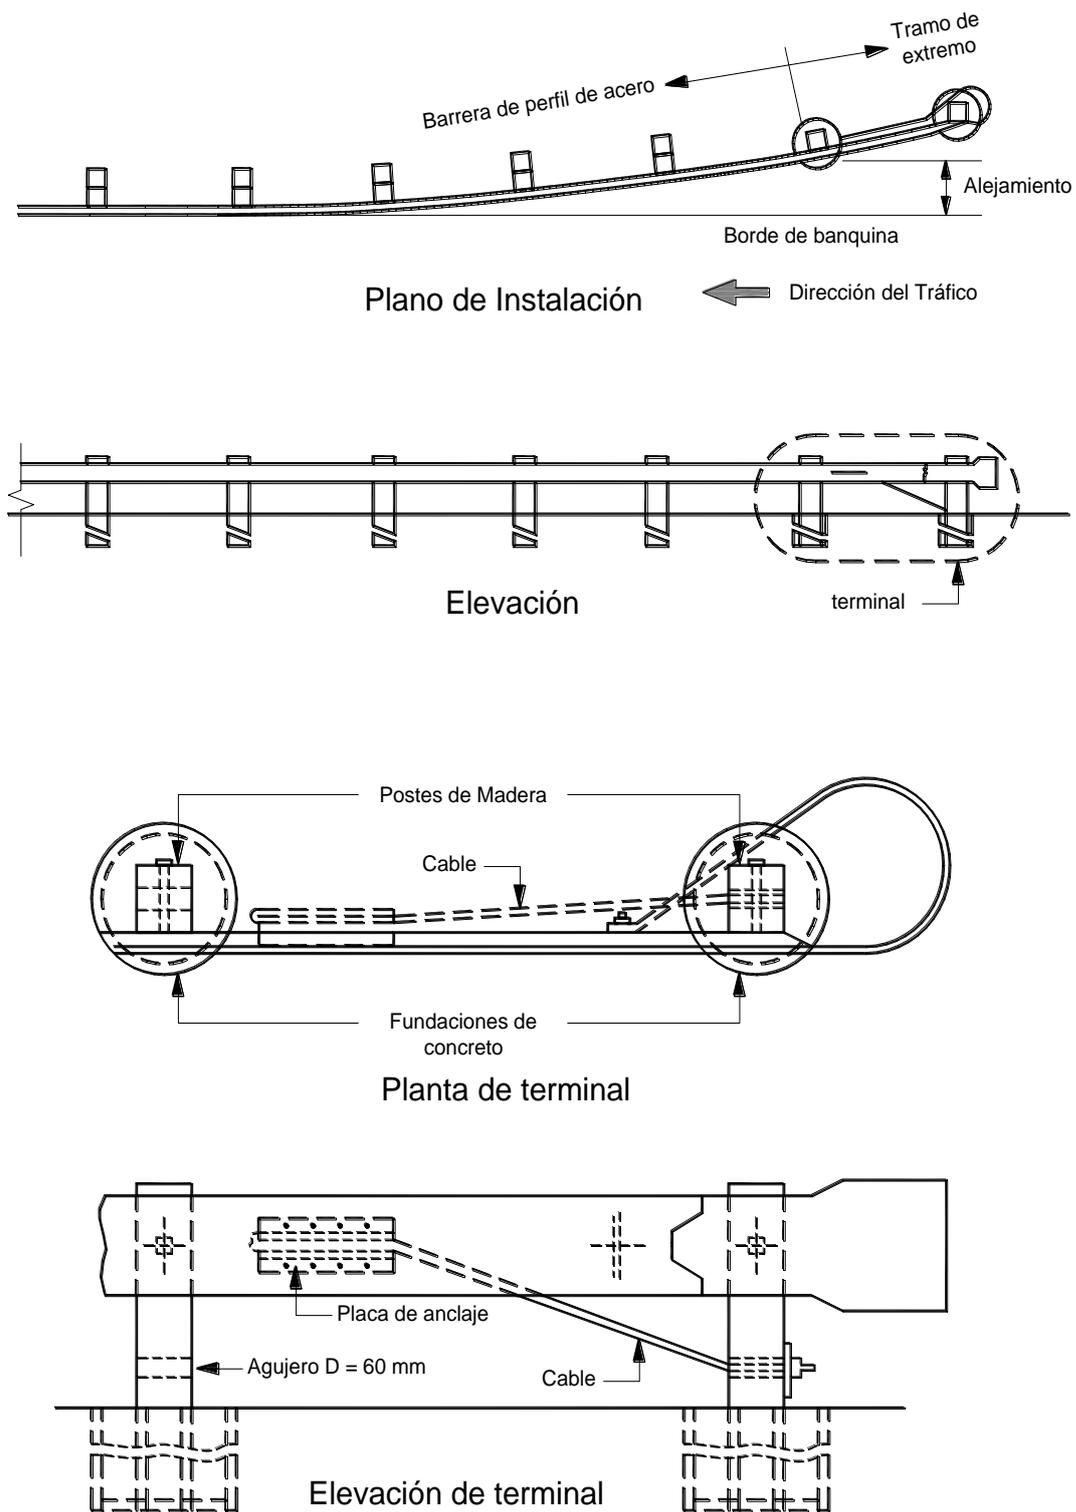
BARRERA DE VIGA DE ACERO CON TRATAMIENTO DE EXTREMO DE CABLE TERMINAL
